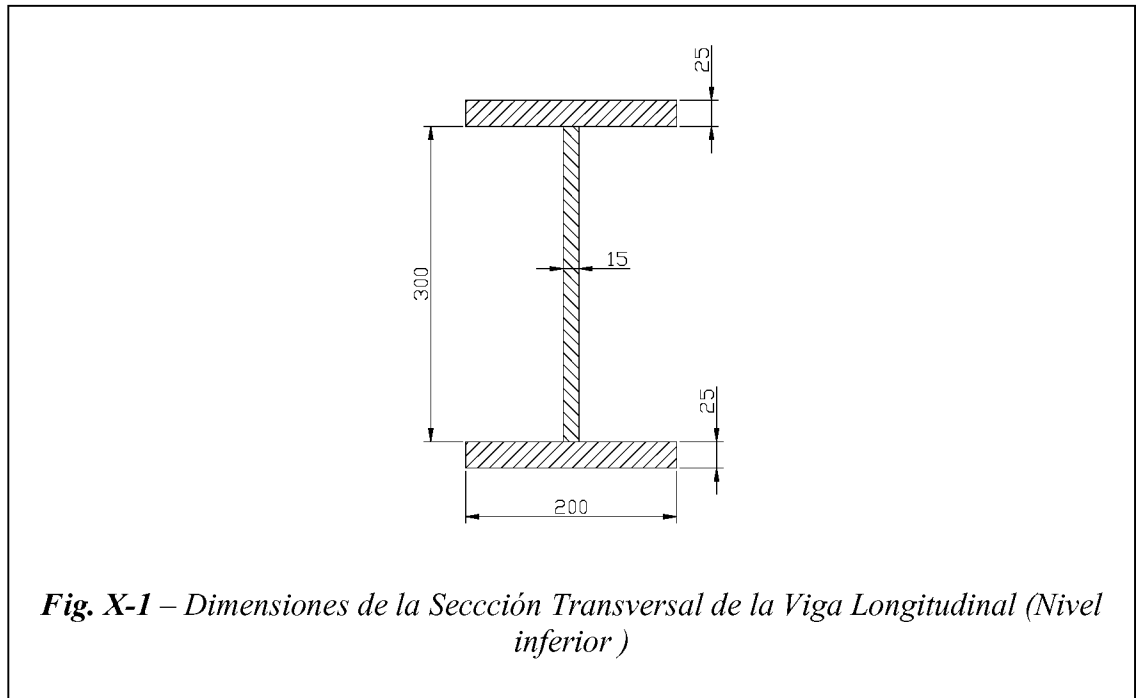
Dimensiones de la Sección Transversal de la Viga Longitudinal (Nivel inferior)
